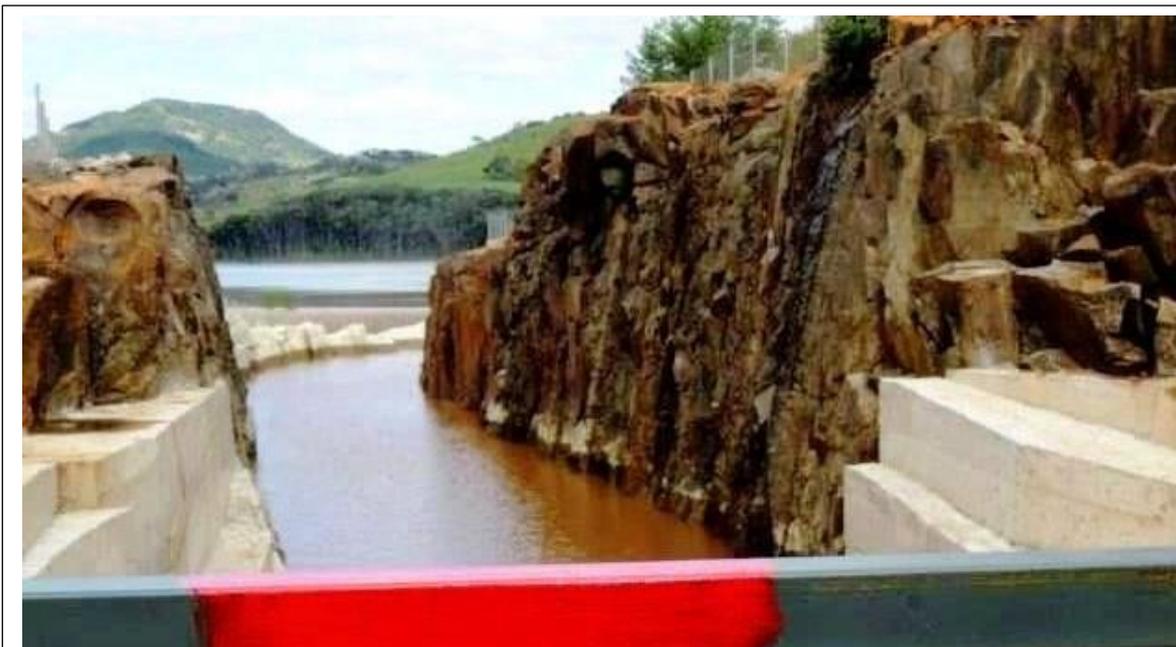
Vista panorâmica Ponto 04: Canal de Adução em 2013
